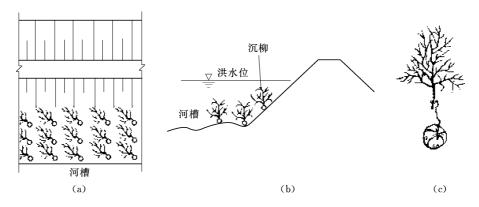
沉柳缓溜防冲示意图 (a) 平面图; (b) 剖面图; (c) 沉柳放大图
